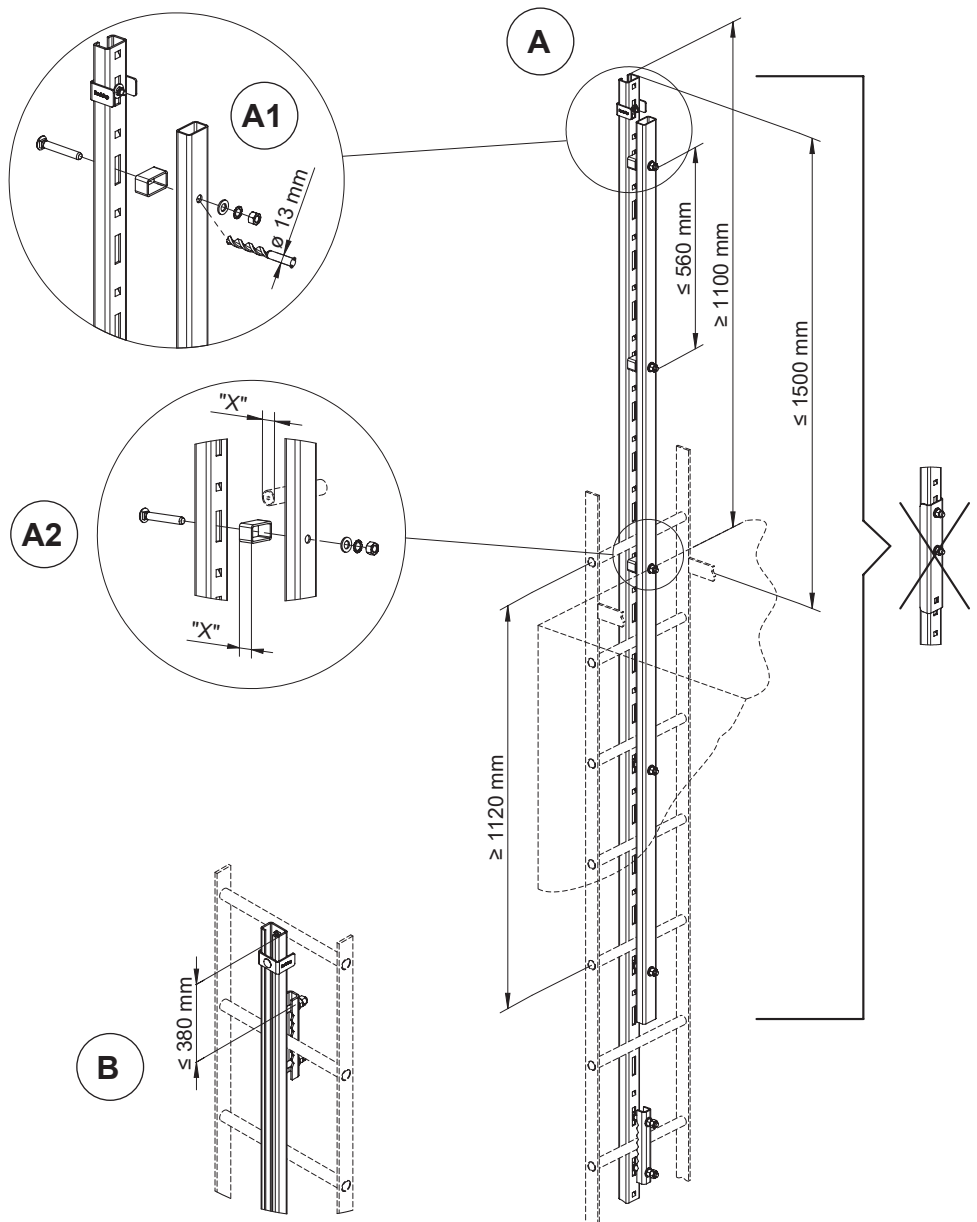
Côté rail supérieur avec (A) et sans (B) armature ; armature d'assemblage et de forage (A1) ; entretoise avec les dimensions basées sur la largeur de l'échelon (A2)
